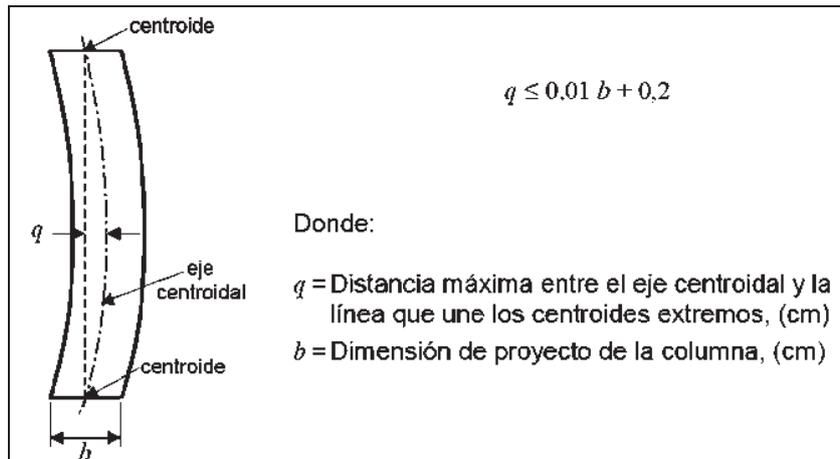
Tolerancia para el combamiento de columnas [16].
